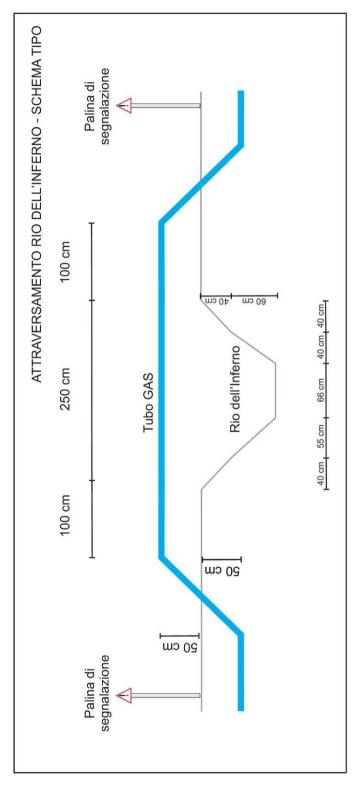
Schema tipo dell'attraversamento della tubazione sul Rio dell'Inferno
